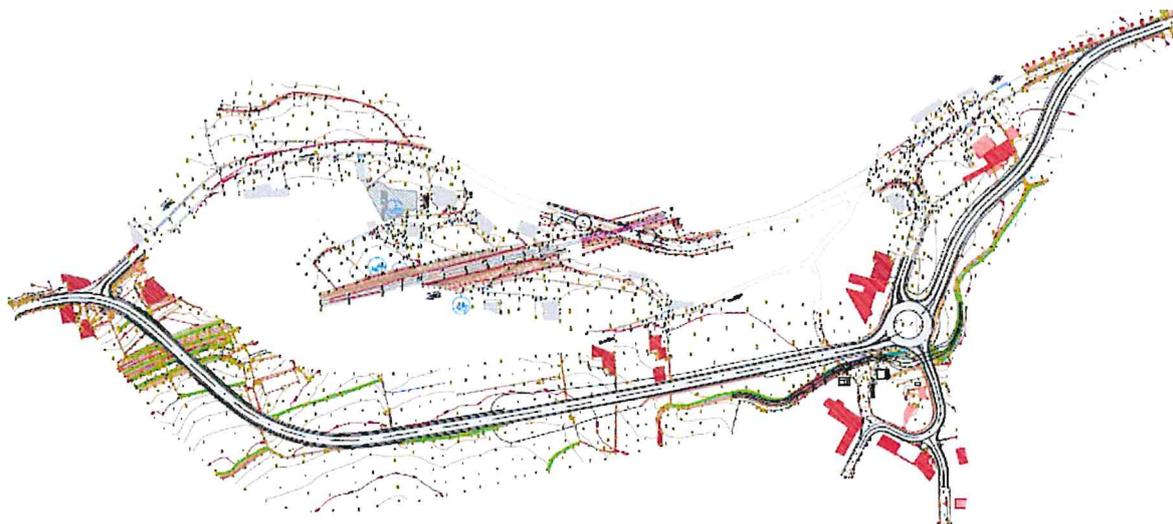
PN ao PK 53,956 (Silva) – Planta Geral da Intervenção Proposta
